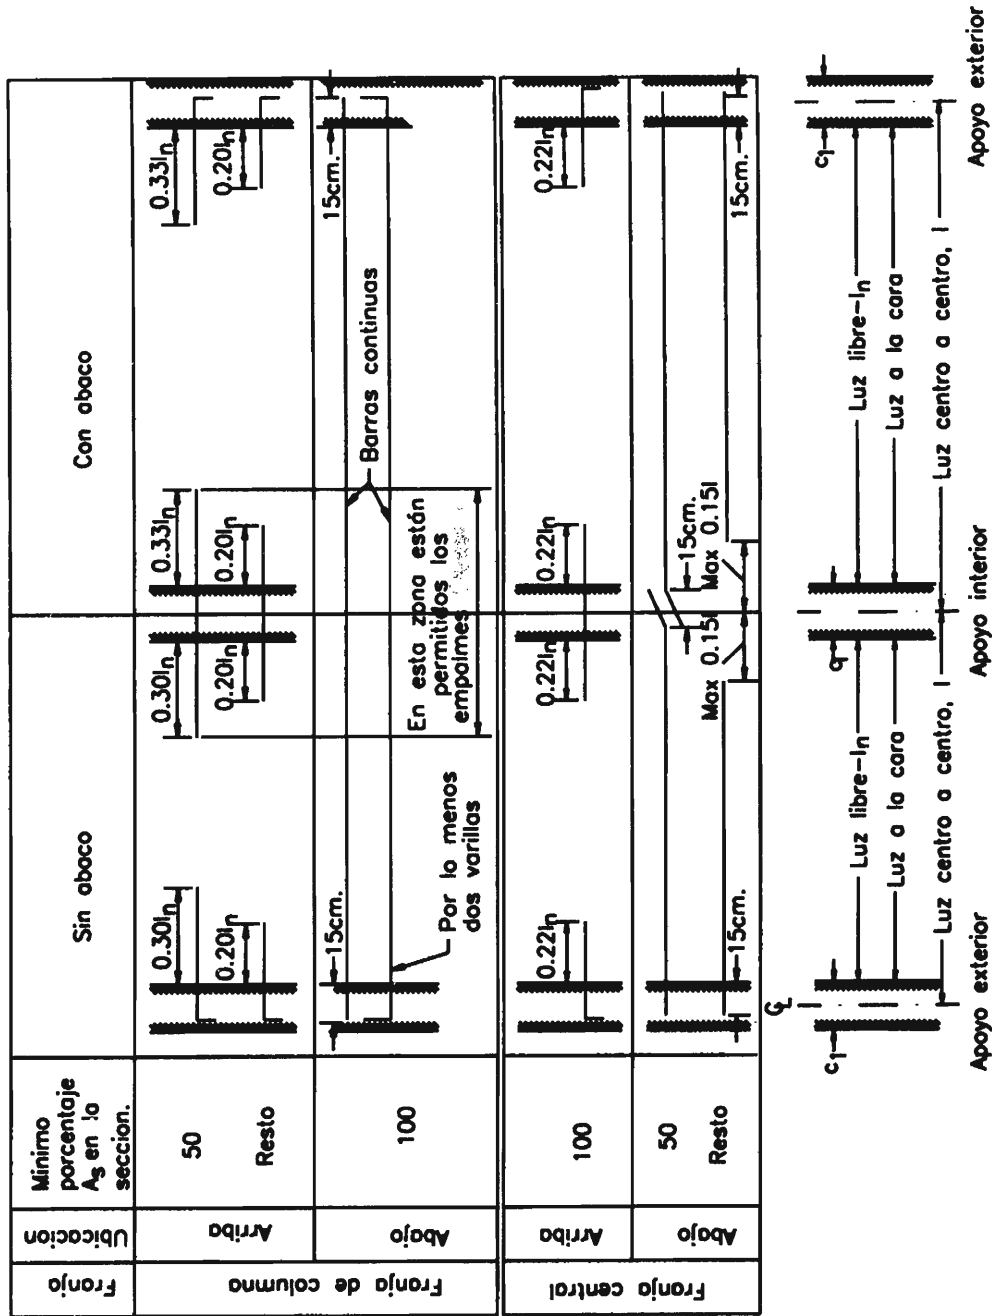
Detallado del refuerzo en losas armadas en dos sentidos sin vigas
